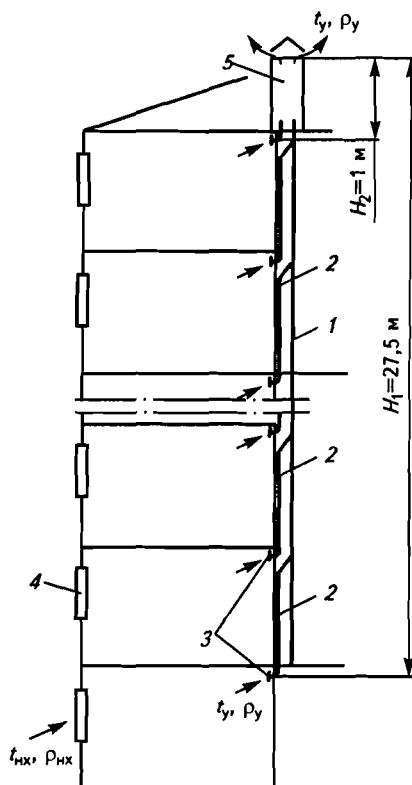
Схема естественной канальной вытяжной вентиляции из кухонь квартир многоэтажного жилого дома
